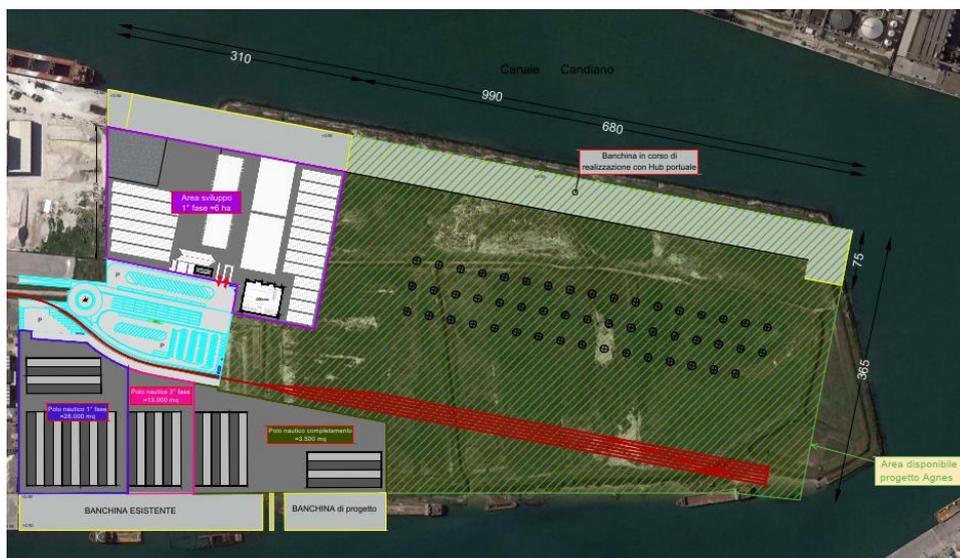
Ipotesi di stoccaggio: monopali in posizione verticale
